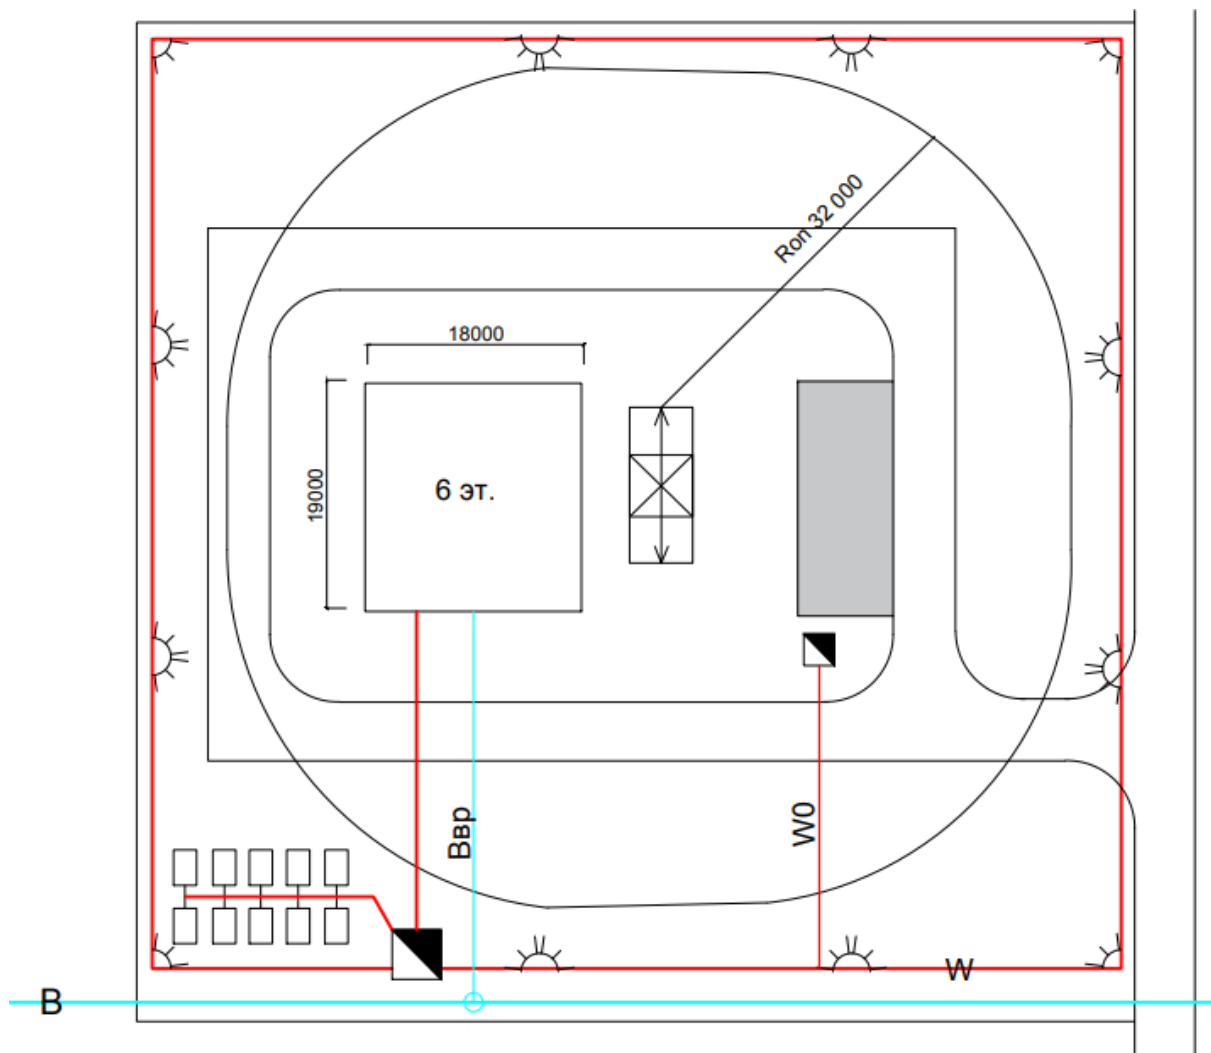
Общеплощадочный стройгенплан на строительство жилого здания.
